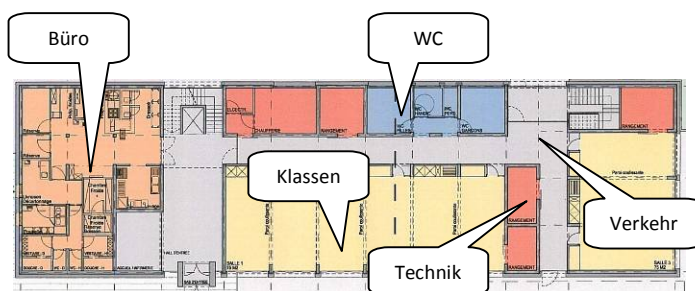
Grundriss Regelgeschoss mit Zonierung, Geb.10
